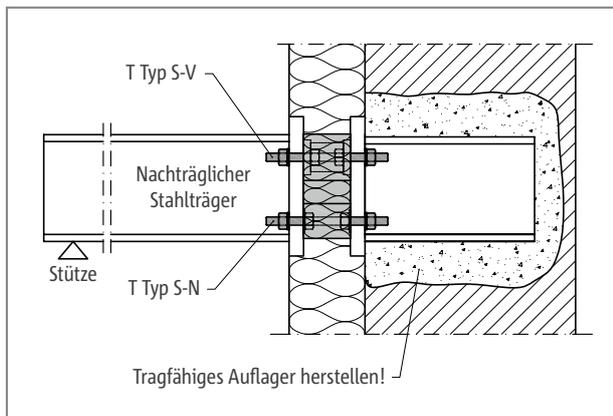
Schöck Isokorb® T Typ S-N und T Typ S-V: nachträglich montierte gestützte Stahlkonstruktion; weitere Beispiele zur Sanierung siehe S. 178
